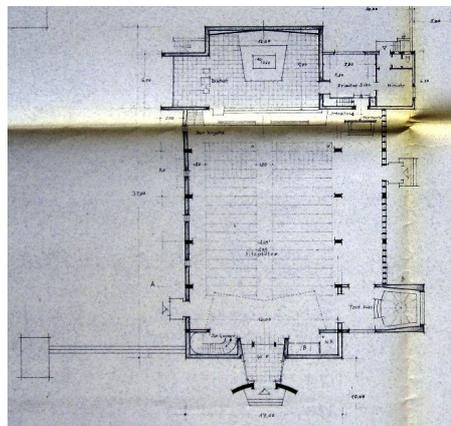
Vorentwurf für den Neubau. Plan 5a, Grundriss (Ausschnitt), O. Hodler, undatiert
